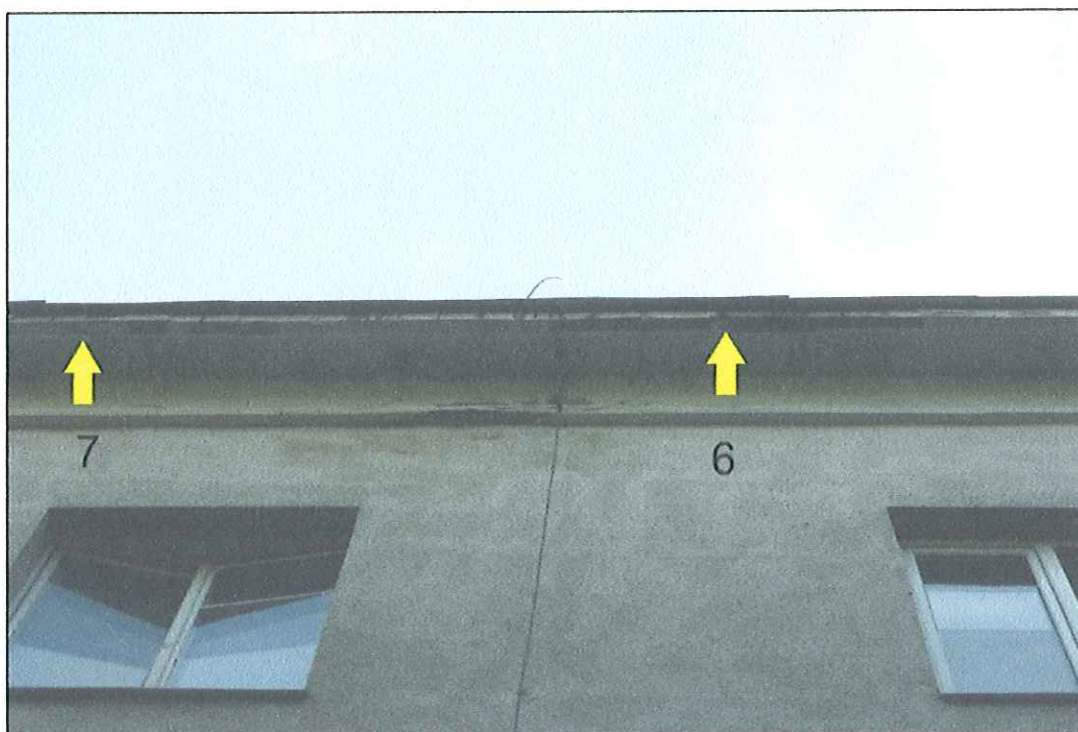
Widok elewacji zachodniej budynku nr 8.
